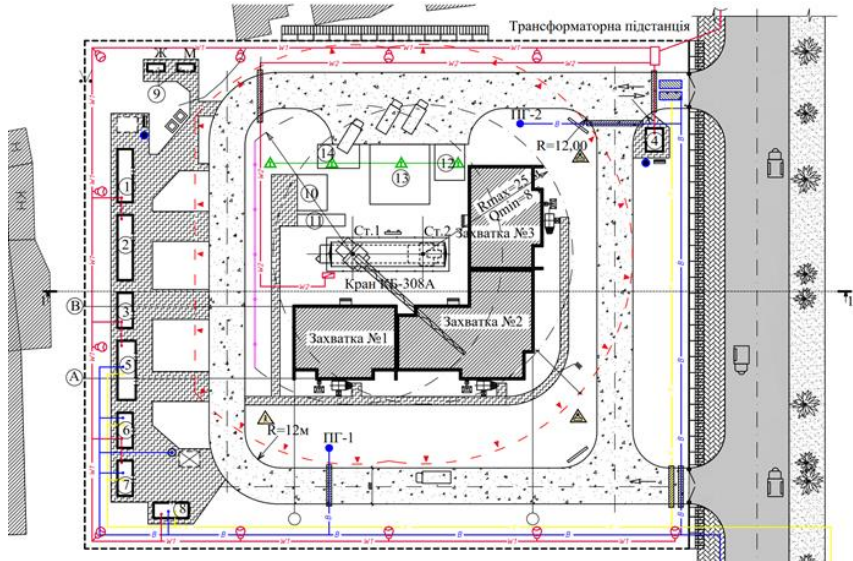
Проектування будгенплану реконструкції типового 3-секційного 5-поверхового житлового будинку з надбудовою мансарди:
